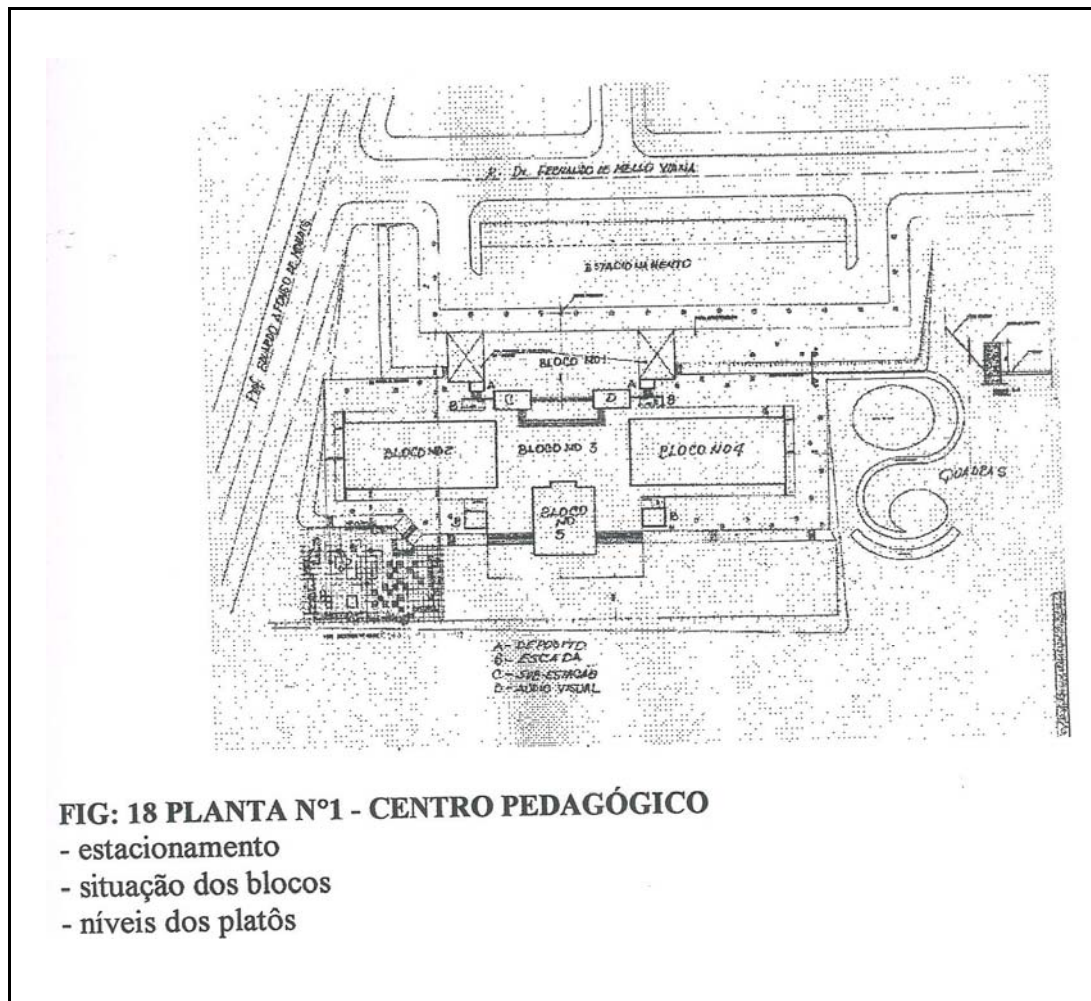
Centro Pedagógico (planta n<sup>o</sup>. 1)
